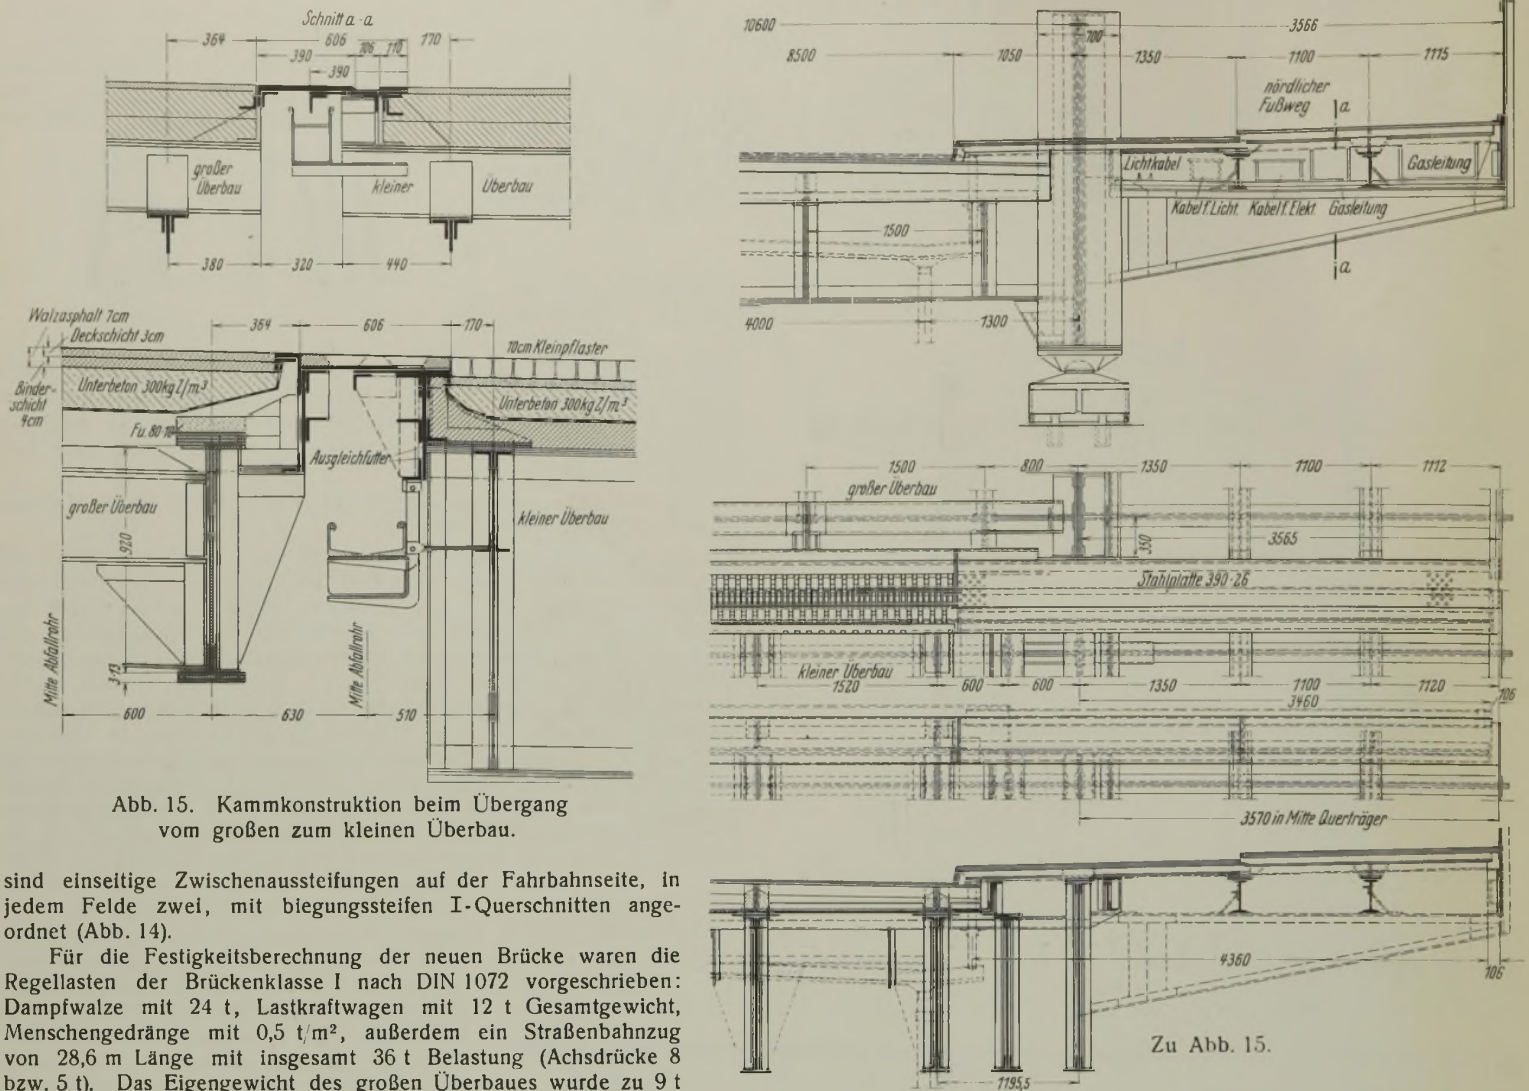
Kammkonstruktion beim Übergang vom großen zum kleinen Überbau.
